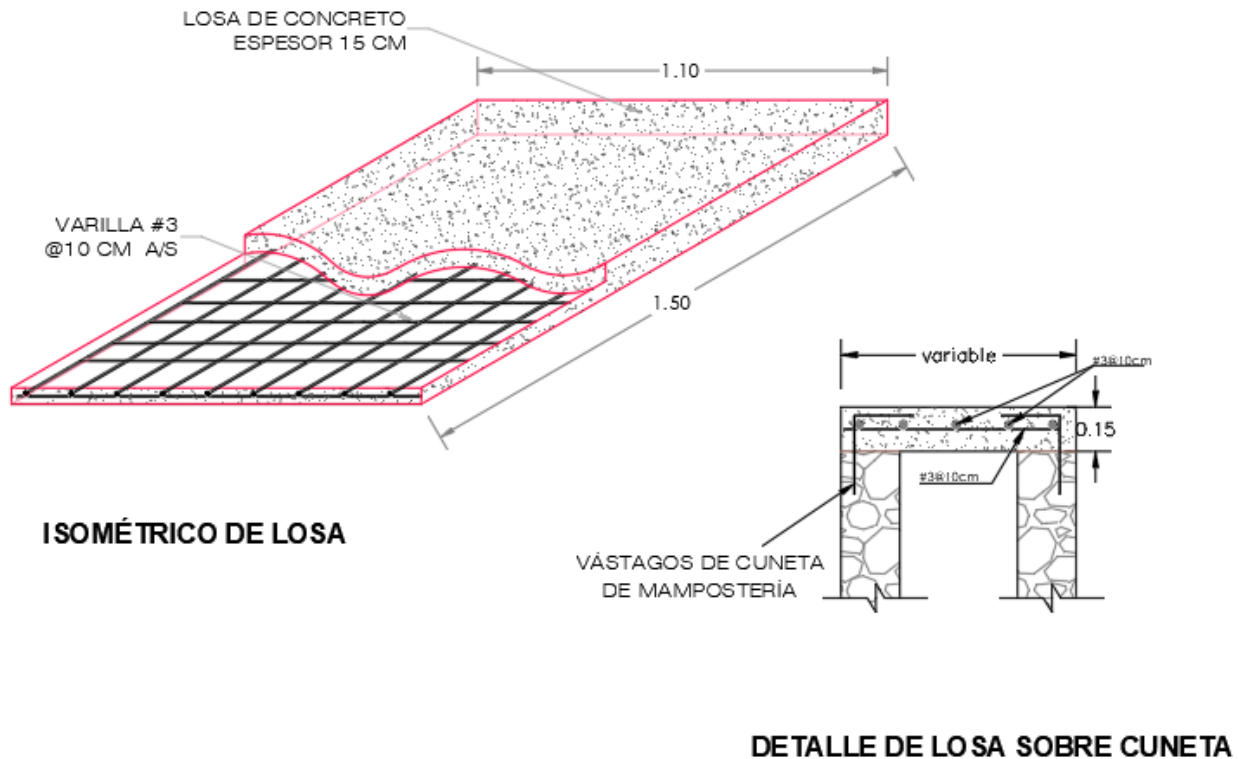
Distribución de refuerzo de acero en la losa de acceso.
